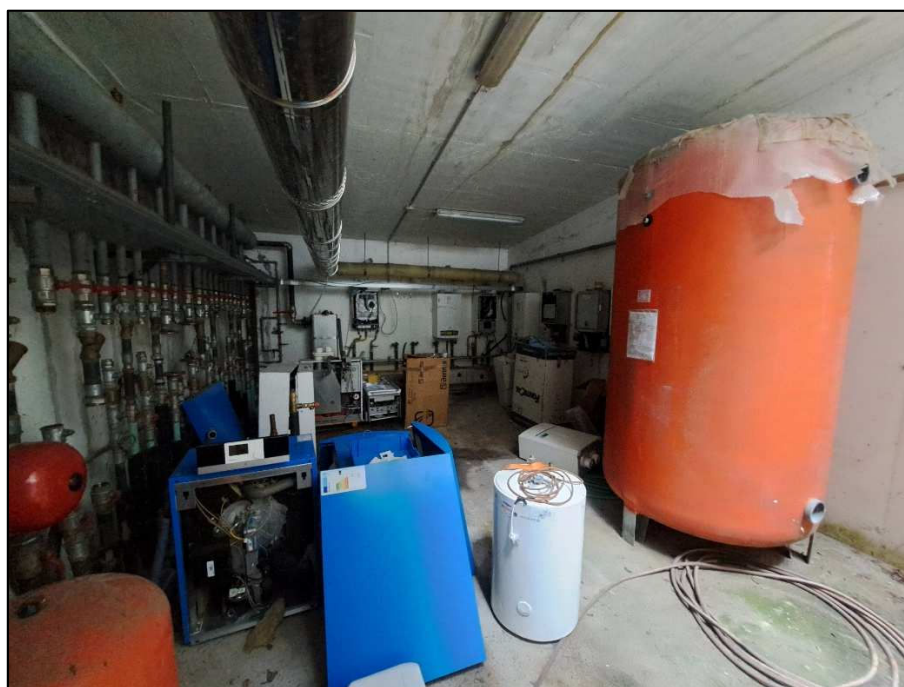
locale comune del frangente nord-est a piano terra adibito a centrale termica, ora dismessa.
